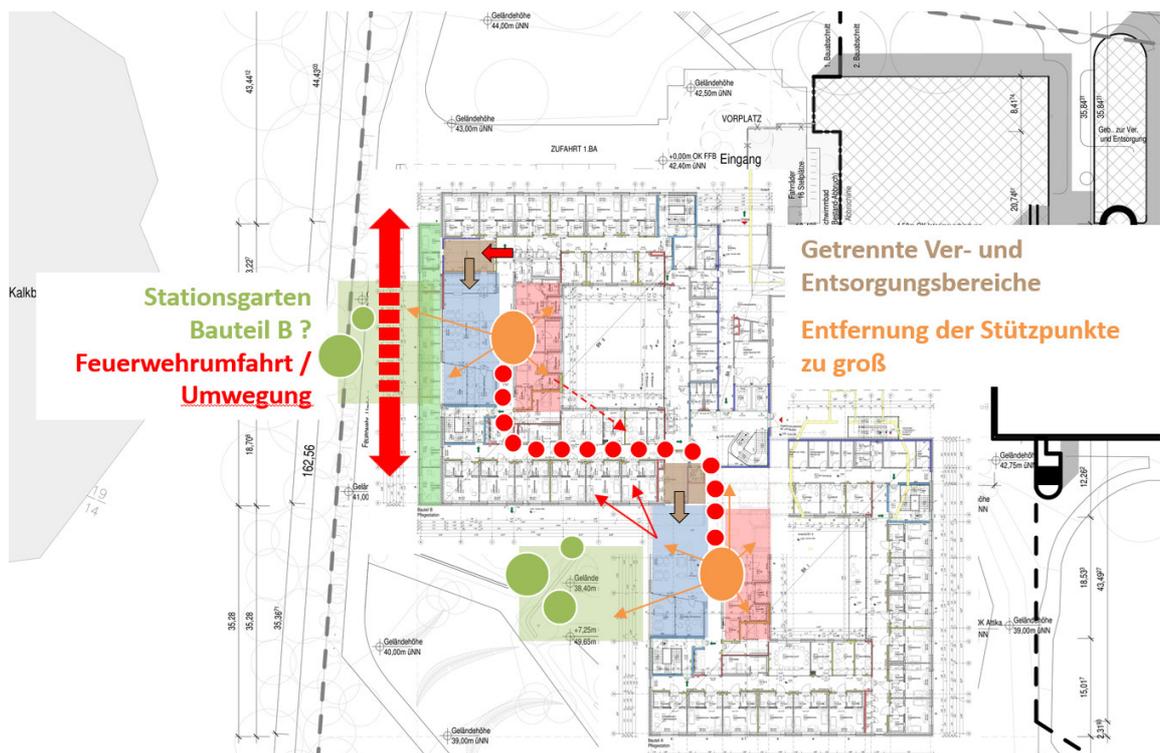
\_ Grundrissstruktur Drehung & Veränderung Bauteil B
